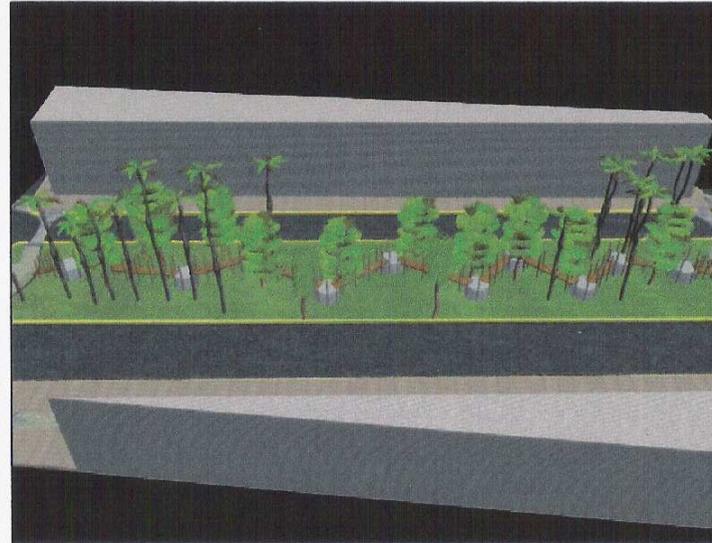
Vista del camellón ubicado entre las calles Ignacio de la Llave y Manlio Fabio Altamirano (sección E). Se observa el camino peatonal a desnivel entre los árboles, este recorrido respeta el emplazamiento de los árboles y la fauna que vive en ellos.
